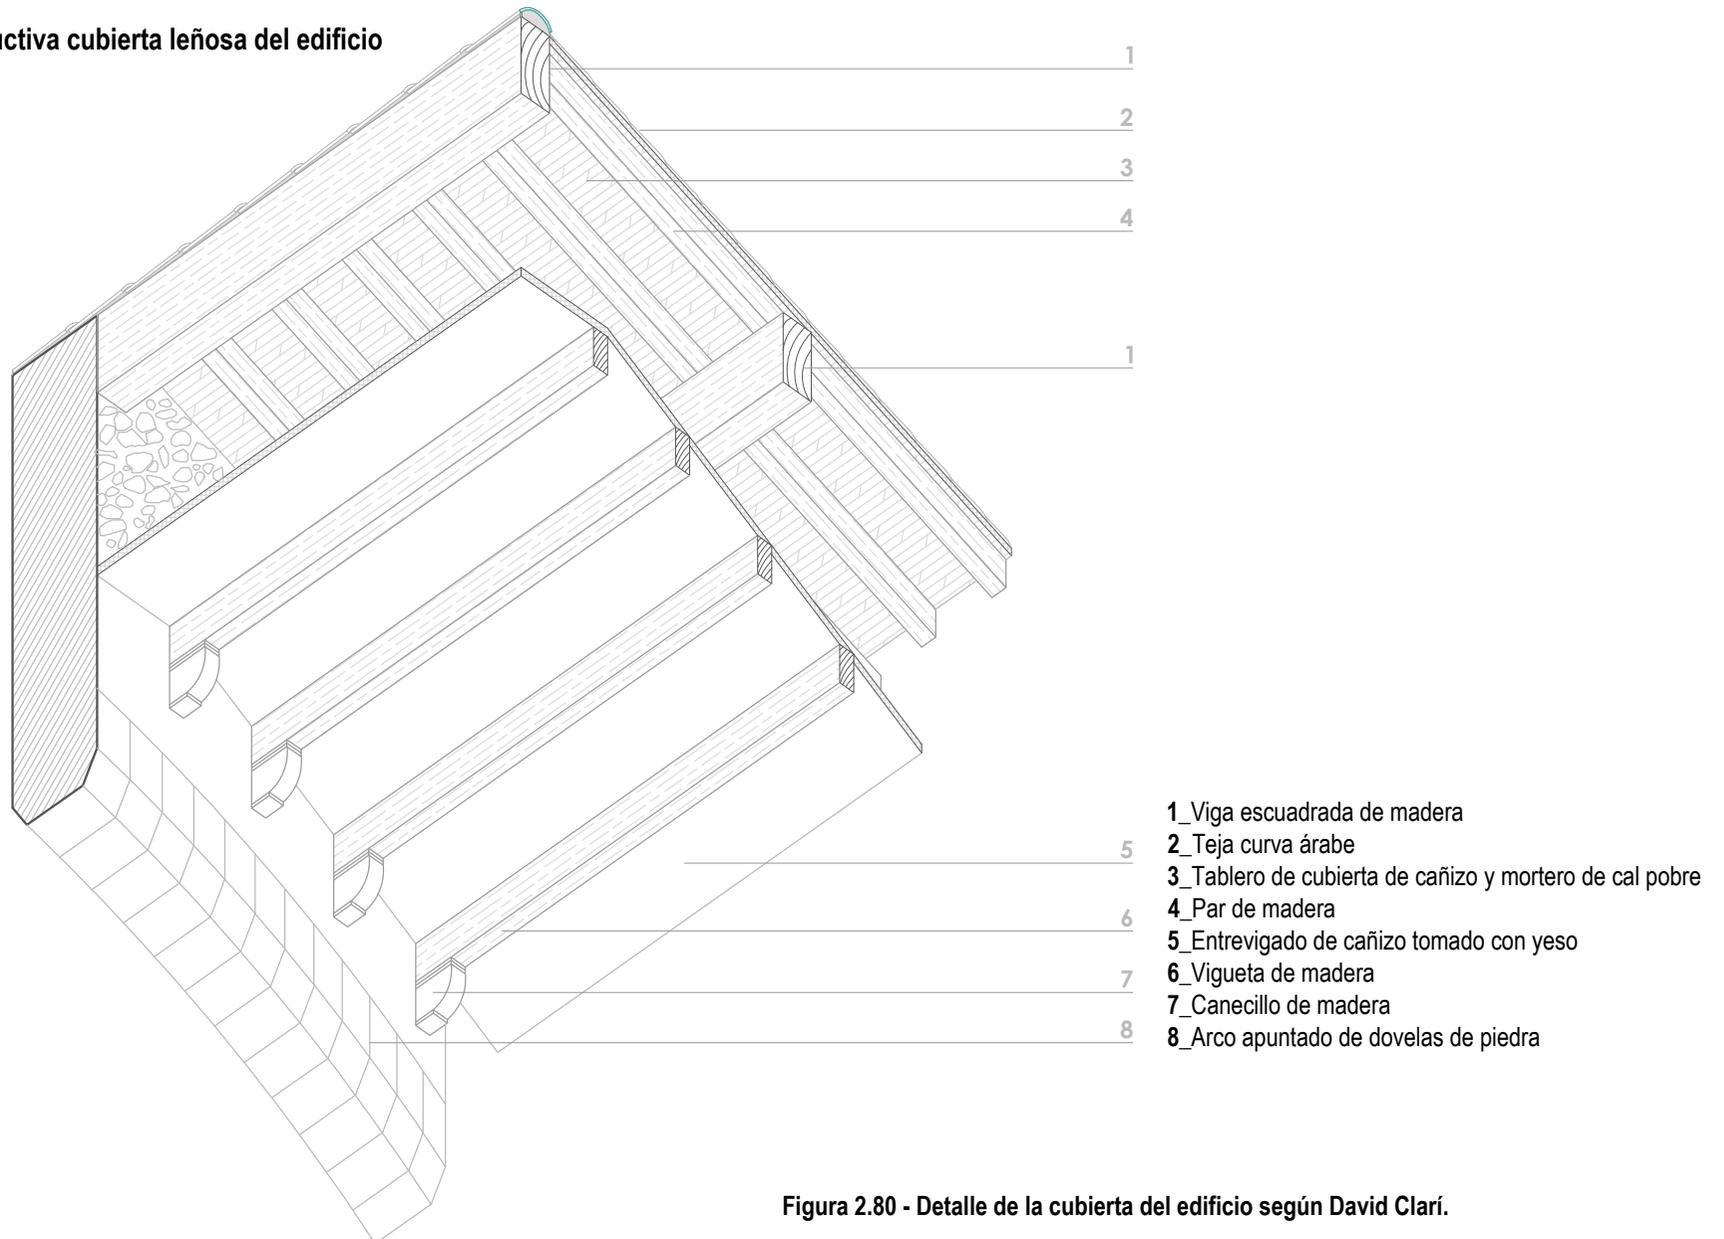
Detalle de la cubierta del edificio según David Clarí.
